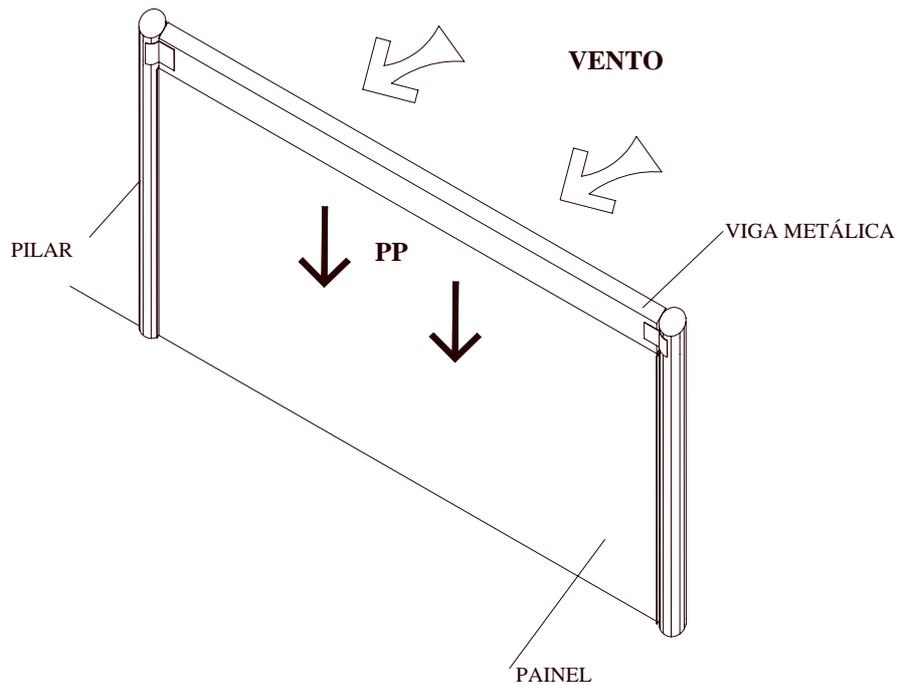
Perspectiva interna mostrando o painel vedação fixado diretamente nos pilares.
